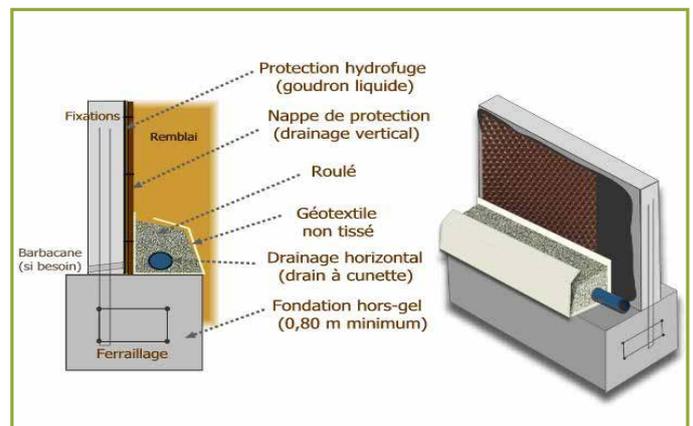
Positionnement du drainage vertical pour un ouvrage maçonné (source : Cédric Houel)
